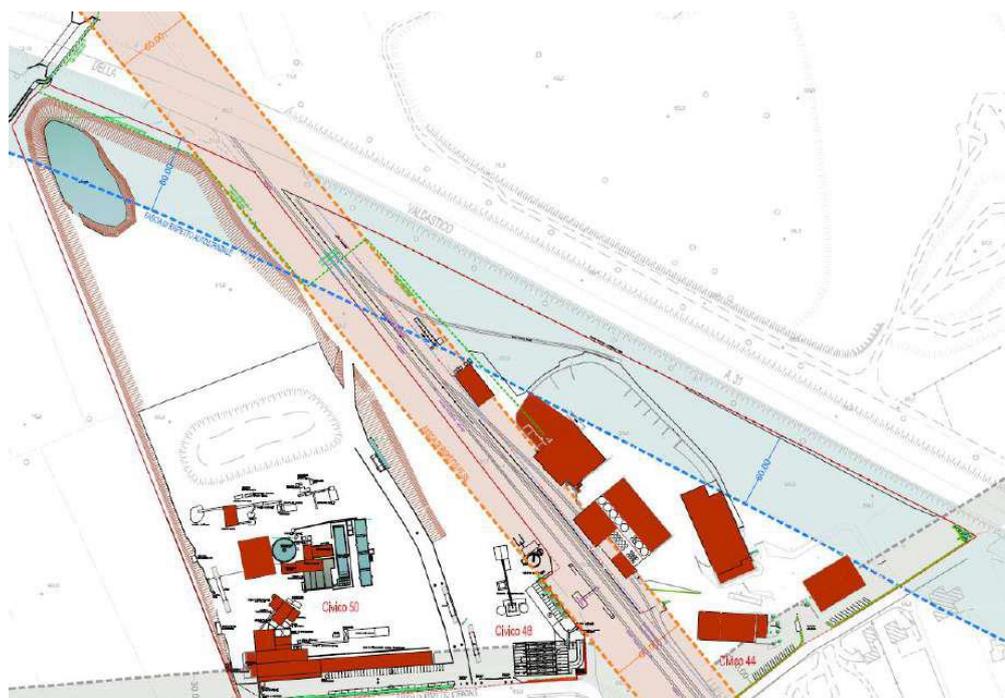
planimetria con indicate le fasce di rispetto (in blu quella dell’autostrada e in arancione quella della ferrovia)
